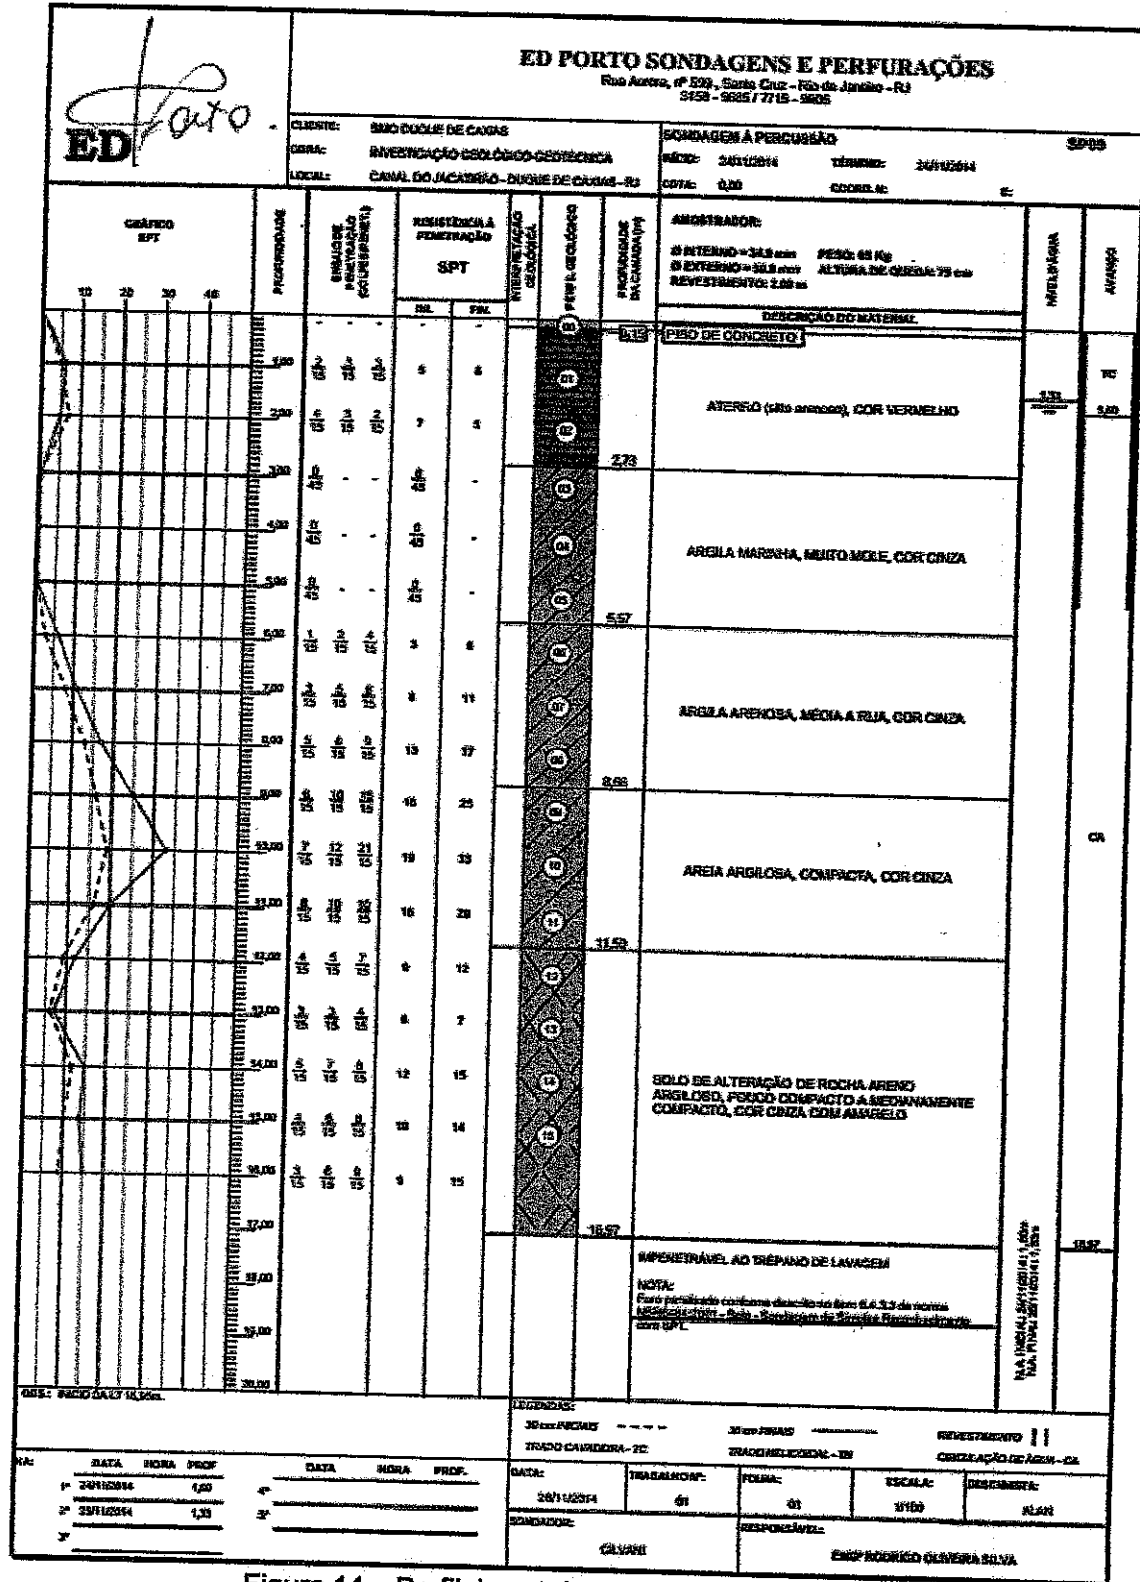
Perfil de sondagem SP-09 (Parte 1/1)
